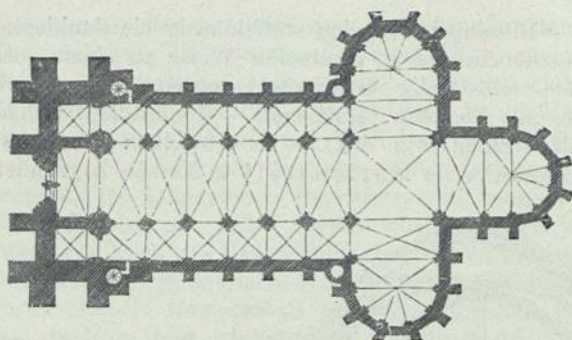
Grundriss der Elisabethkirche zu Marburg
